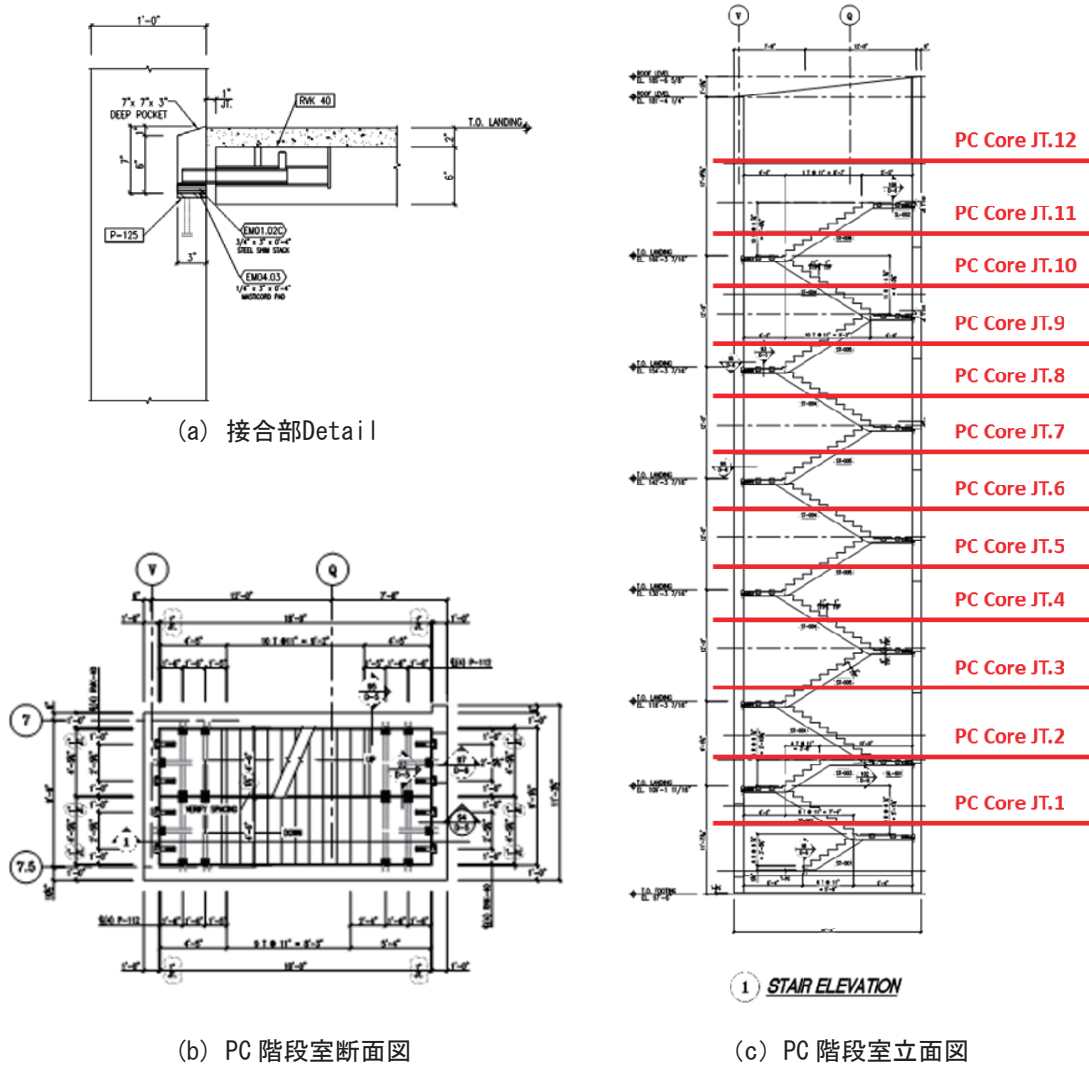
プレキャストコンクリート階段室断面図および接合部詳細
